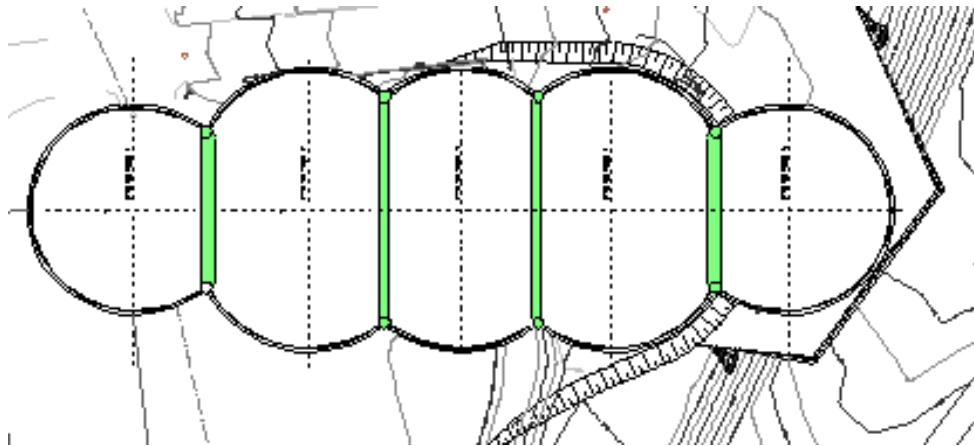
Planta das vigas de travamento dos poços 1 a 5 (Adaptado CJC, 2009).
